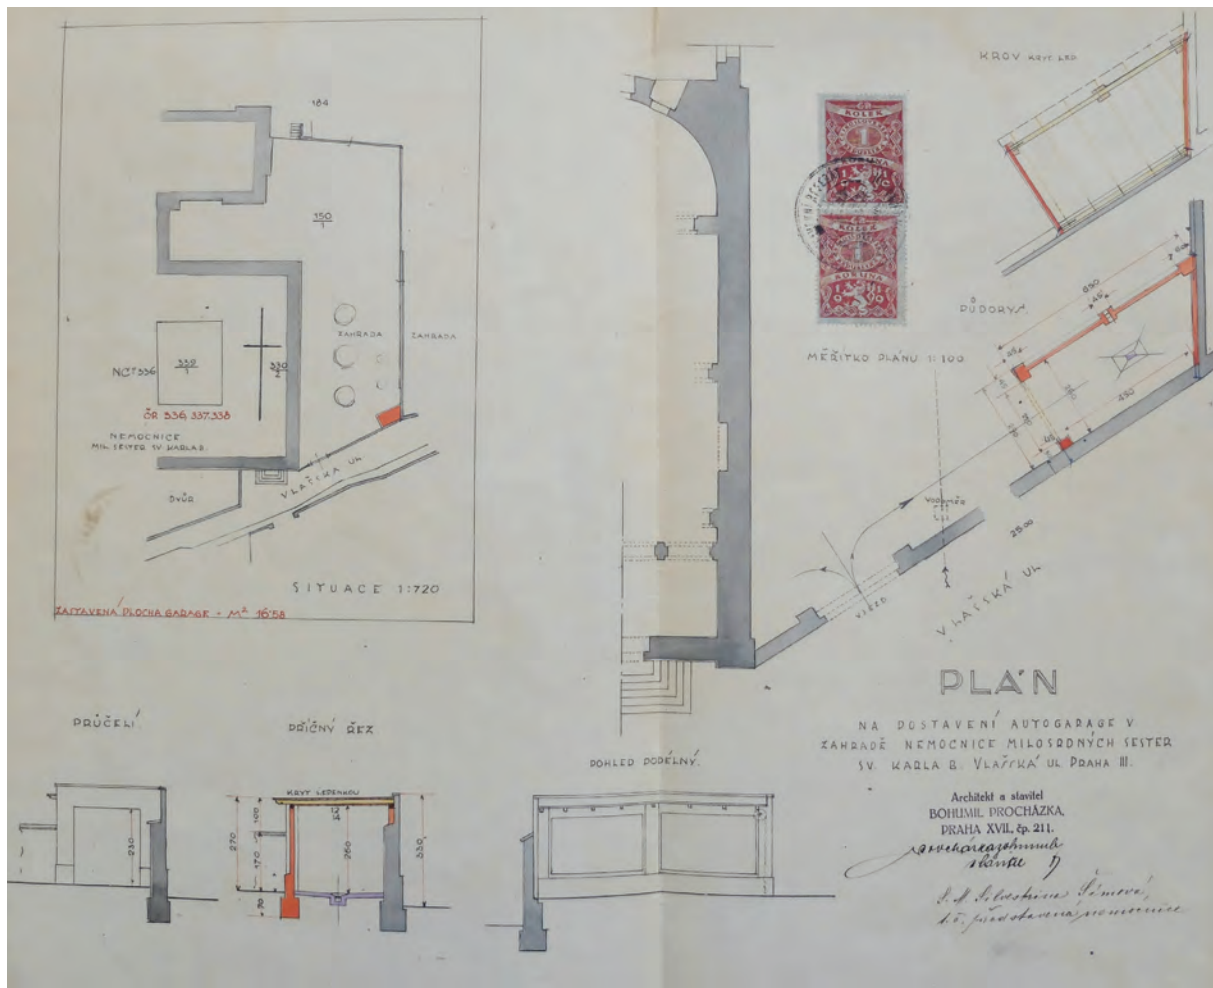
Plan zum Bau einer Autogarage im Garten des Krankenhauses, Architekt und Bau-
